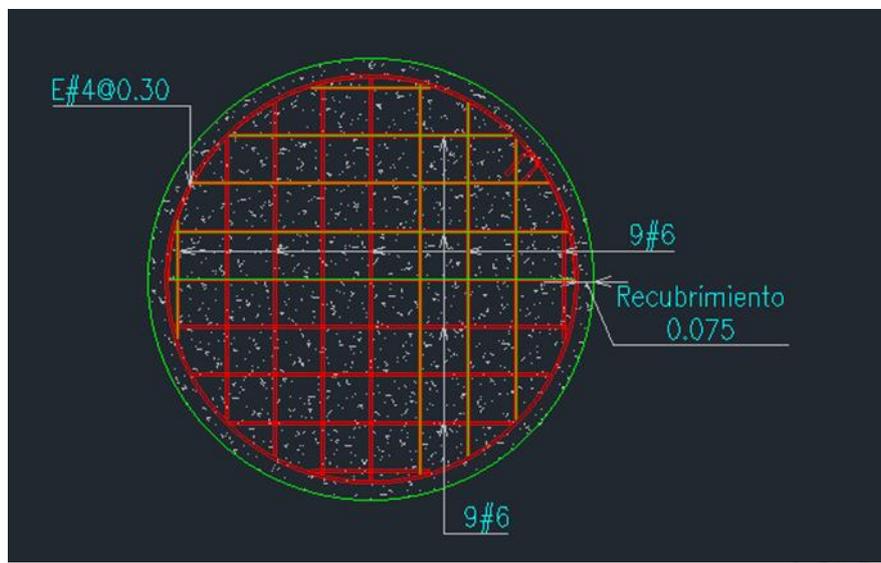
Ejemplo de acero en la base de una pila (Fuente: elaboración propia)
